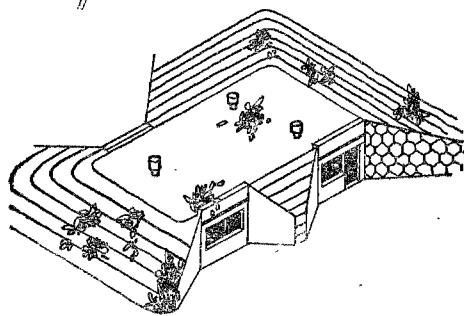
Основные конструктивные схемы жилых зданий:
